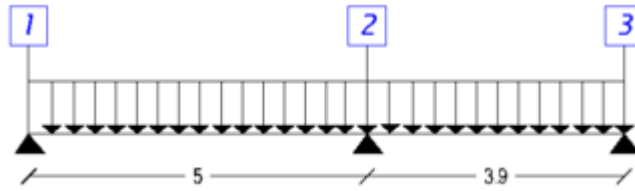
Schéma statique de Poutrelle du Type 4
